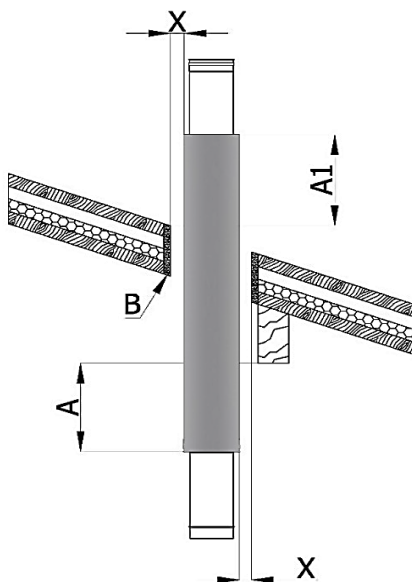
Attraversamento a tetto ventilato con travetto trasversale
